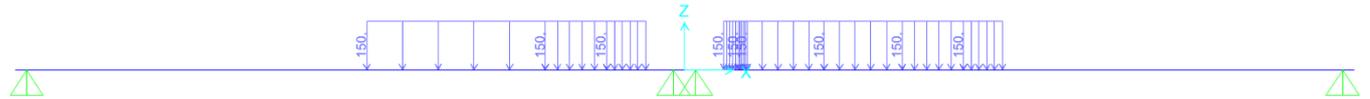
disposizione di carico 6 - SW/2 – pila 2
